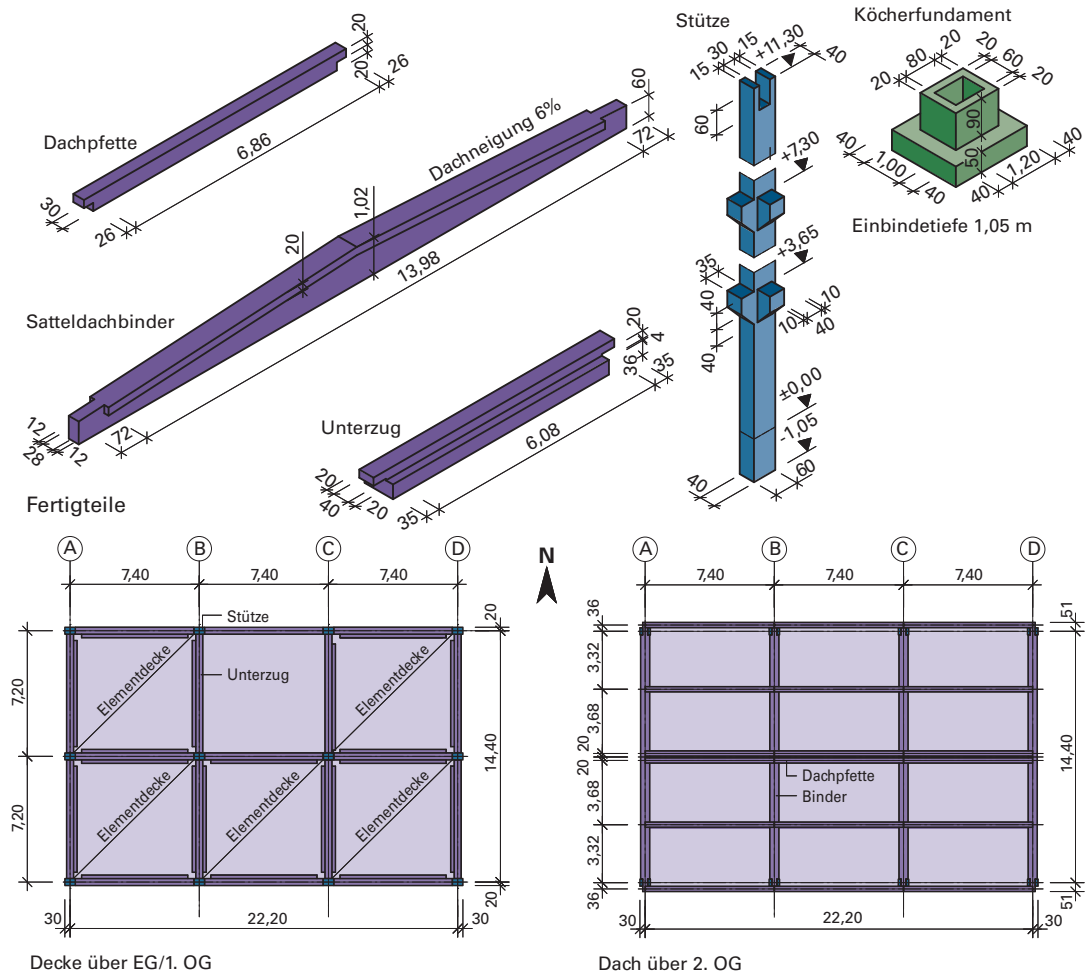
Verwaltungsgebäude aus Stahlbetonfertigteilen
